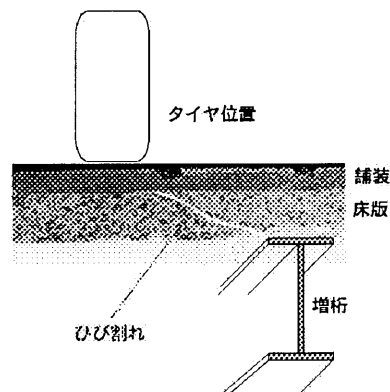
せん断型疲労ひび割れが発生している状況
